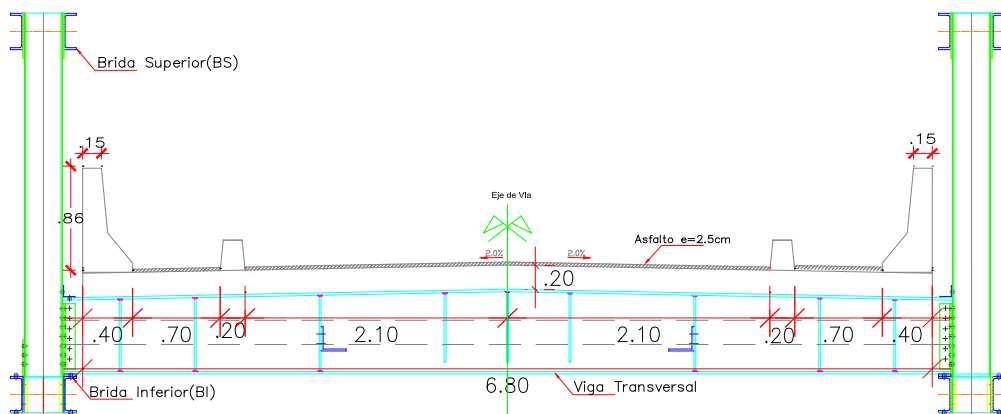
Sección transversal del puente colgante "El Triunfo"
